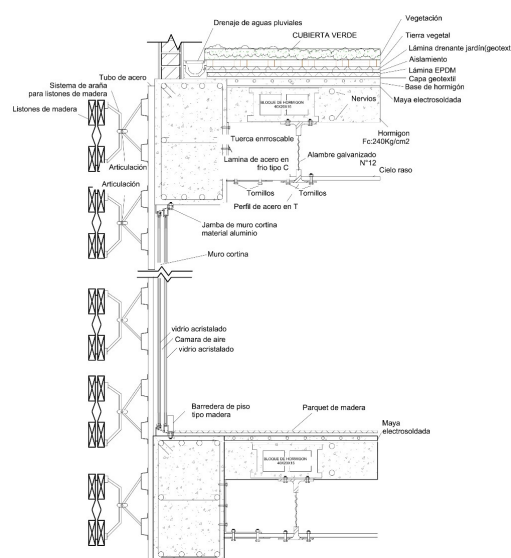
Detalle constructivo de lamas de madera movibles. Fuente: Elaboración propia
